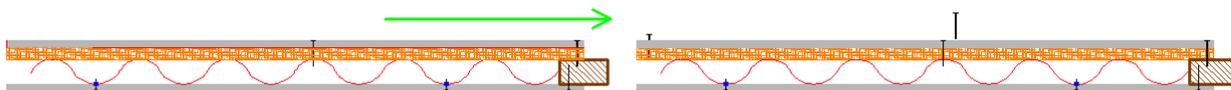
Detalhamento de travamento dos painéis: tipo macho-fêmea
